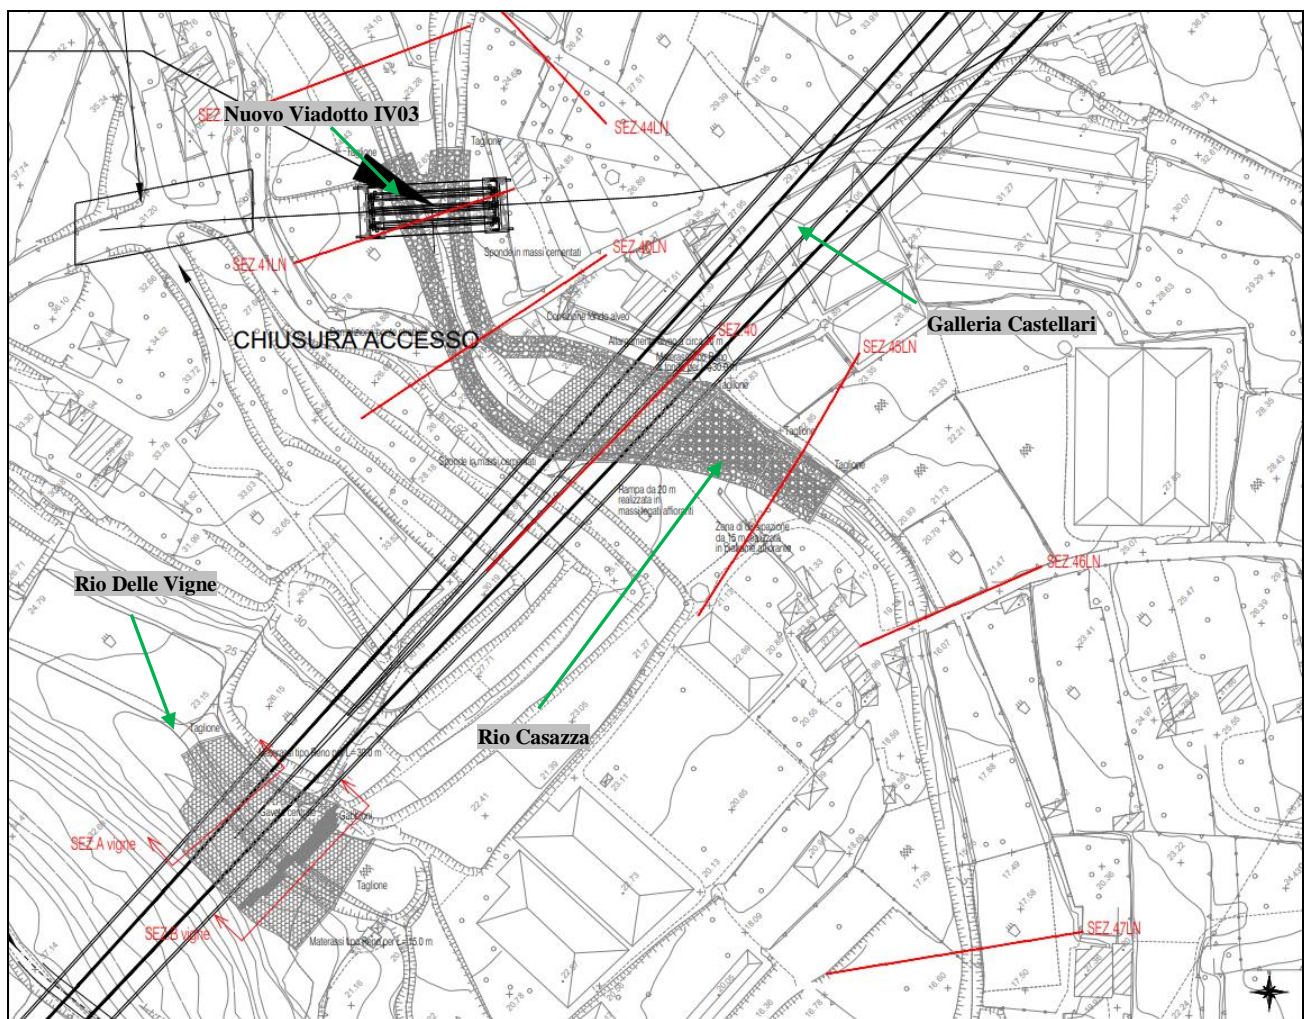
Stralcio della planimetria di progetto in quel di Borghetto Santo Spirito
